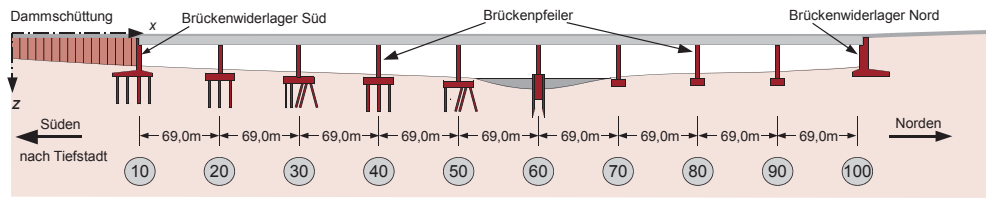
Beispiel Straßentrasse Damm-Brücke, Bauwerke und Stationierung
